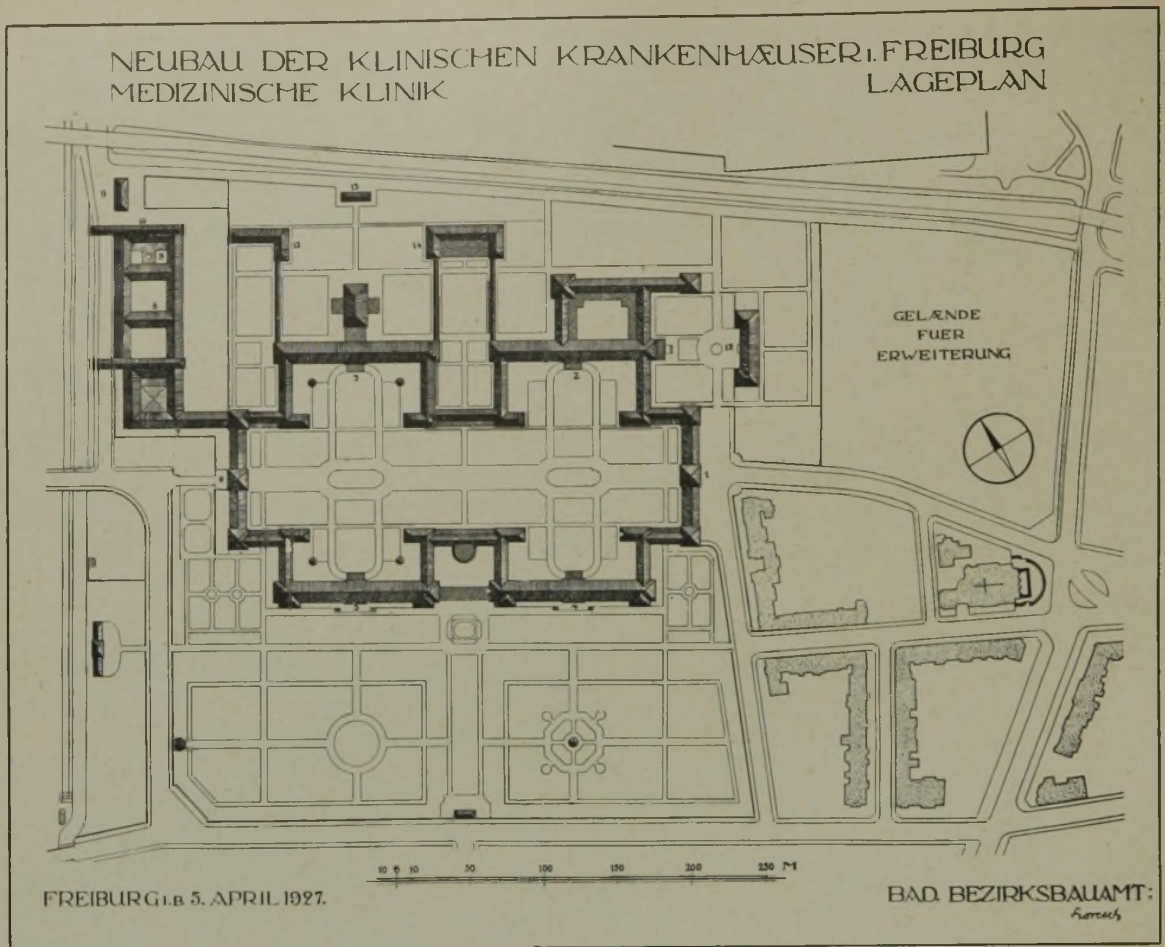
Lageplan. (Maßstab 1 : 5000.)
